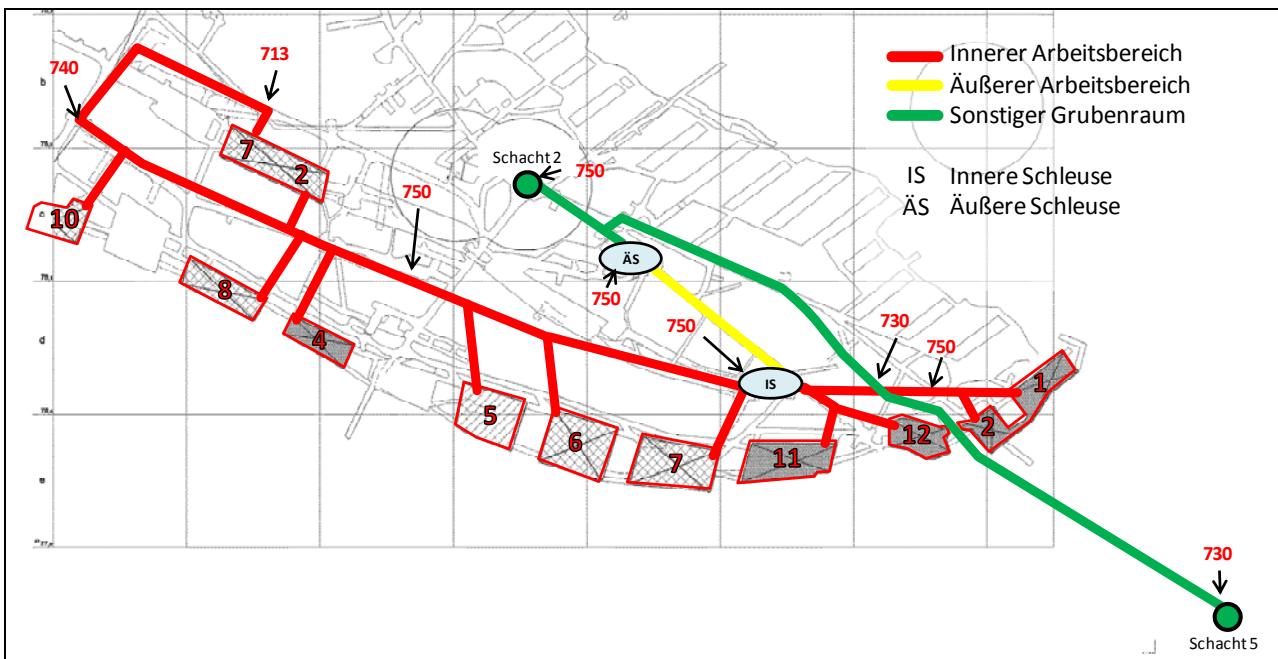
Schematische Darstellung der Variante 1 – Rückholung von Norden von der 750-m-Sohle (Hintergrund: Grundriss der 750-m-Sohle).
